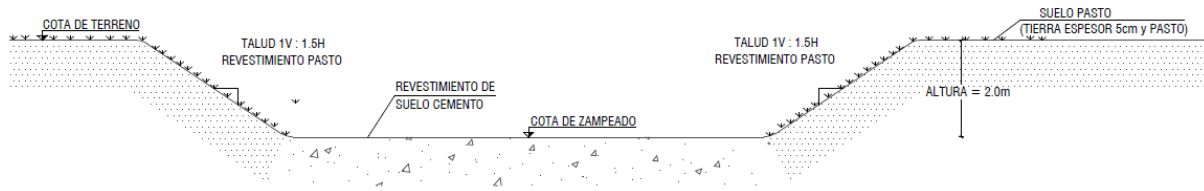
Esquema de sección trapezoidal a construir en la cañada
